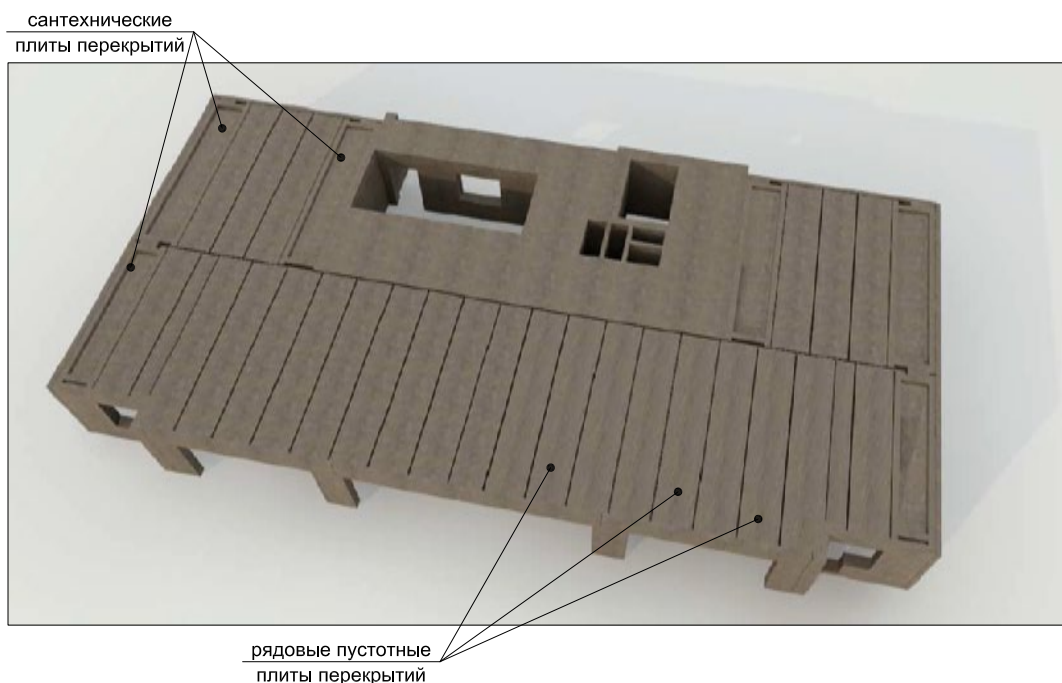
Панельно-каркасная система с поперечной раскладкой многопустотных плит
